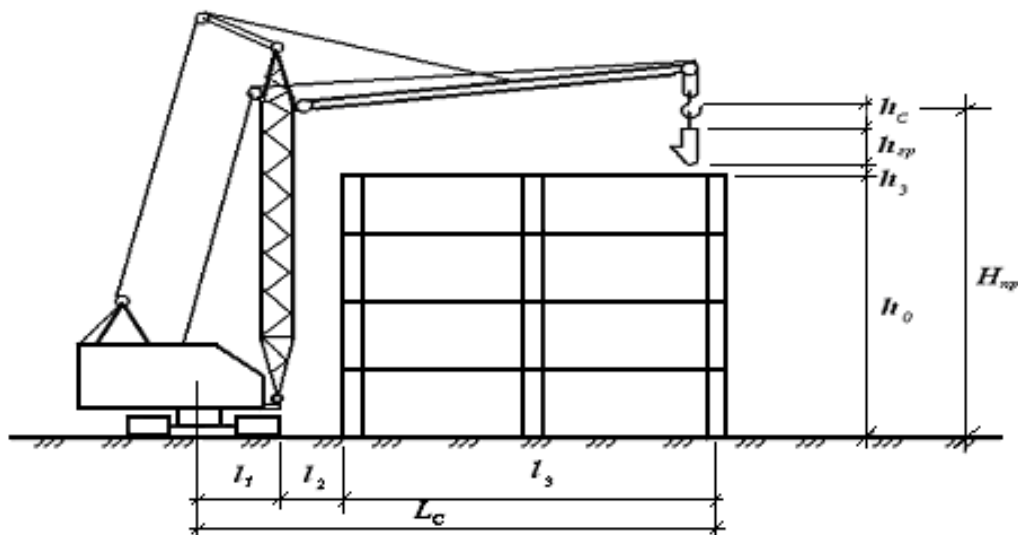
Схема определения параметров крана, оснащённого башенно-стреловым оборудованием
